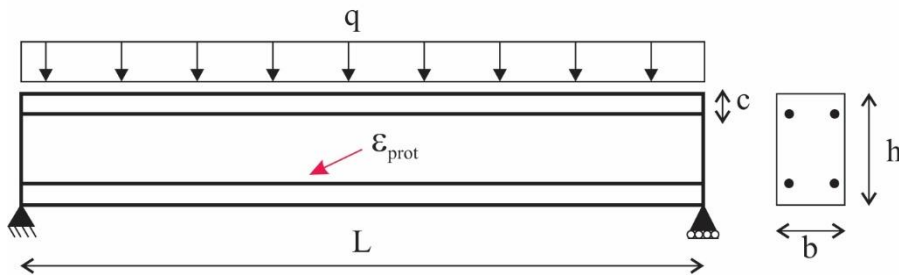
Esquema estático e geometria para o exemplo de uma viga biapoiada com protensão nas barras inferiores.
